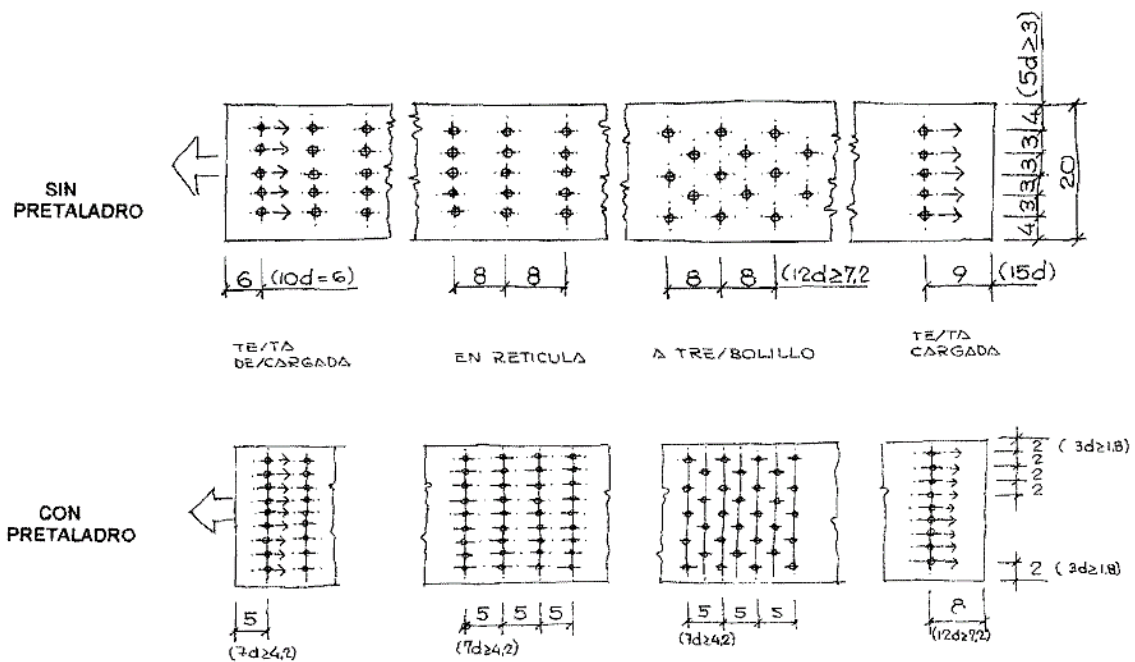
Distancias mínimas de clavos a testas y bordes, y separaciones entre clavos en tableros de apeo, unidos por sus caras anchas para esfuerzos en dirección paralela a la fibra.
